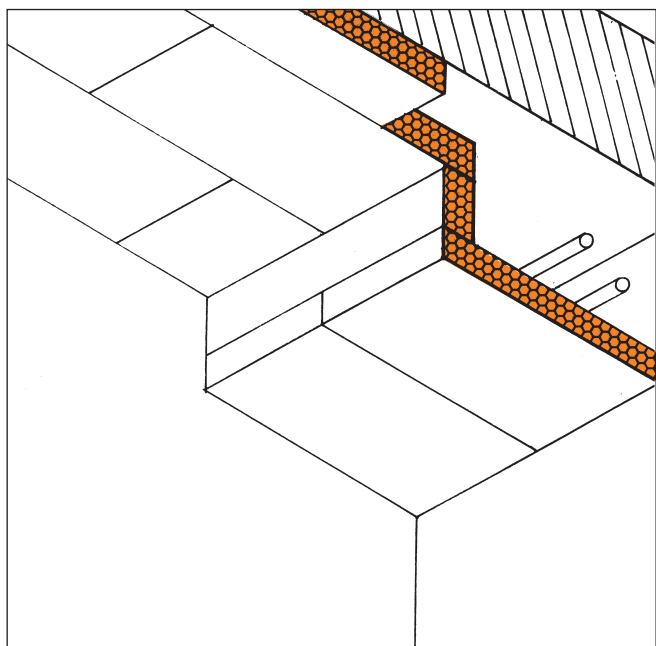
Isolamento di soffitto di scantinato. Le tubazioni a vista possono essere facilmente nascoste.
